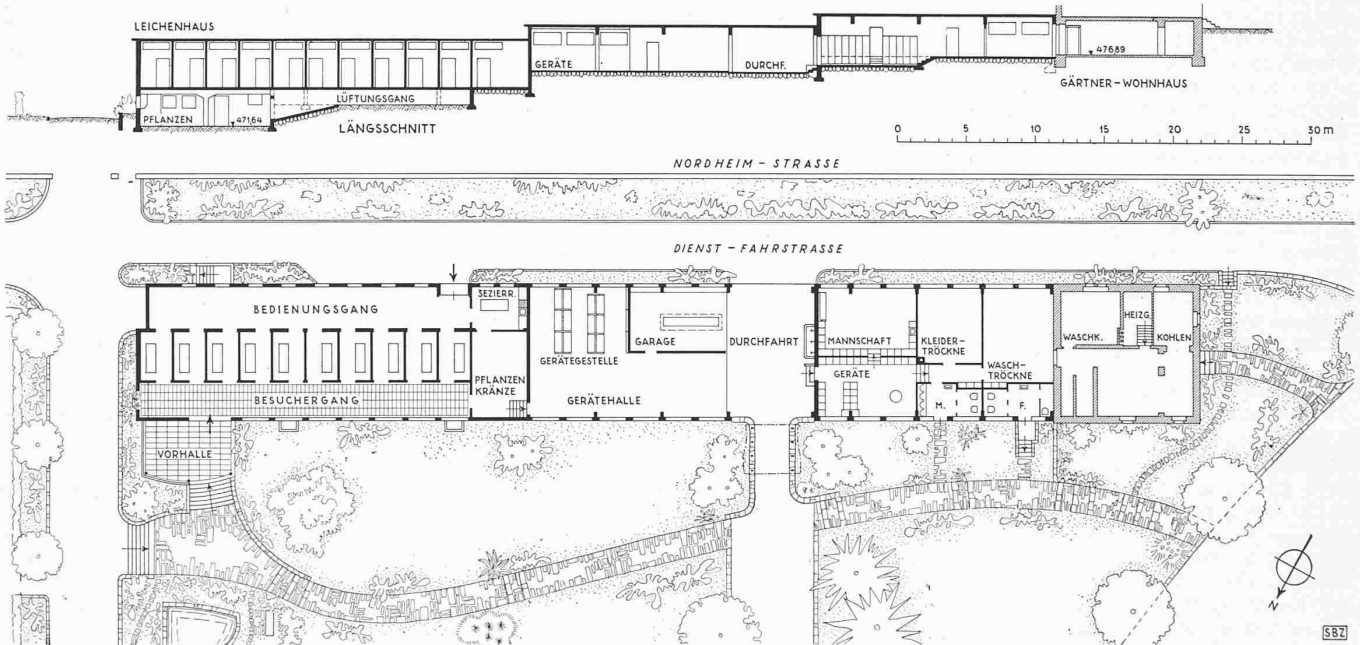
Leichenhalle und Dienstgebäude im Friedhof Nordheim, Zürich. Grundriss und Längsschnitt 1:500
